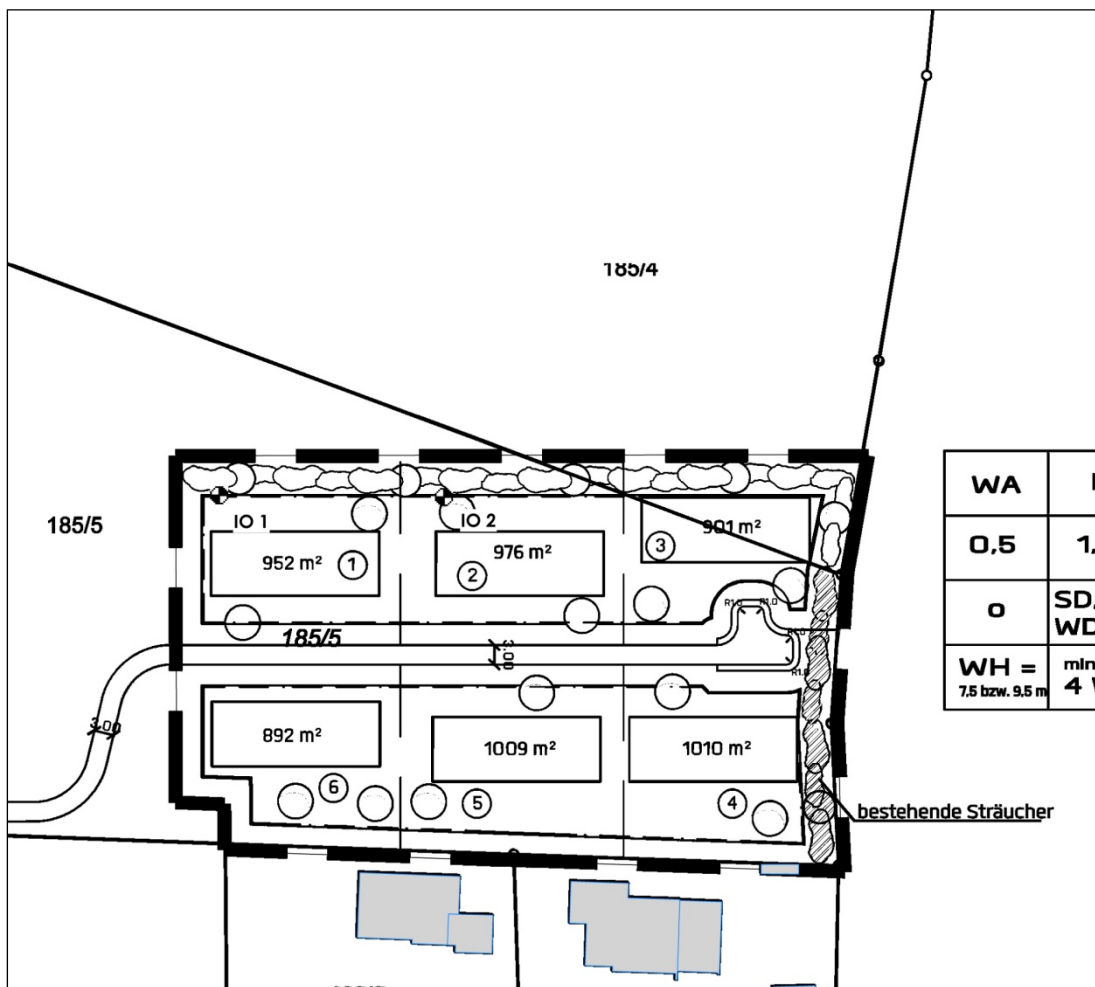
Lageplan mit Darstellung der exemplarischen Immissionsorte
